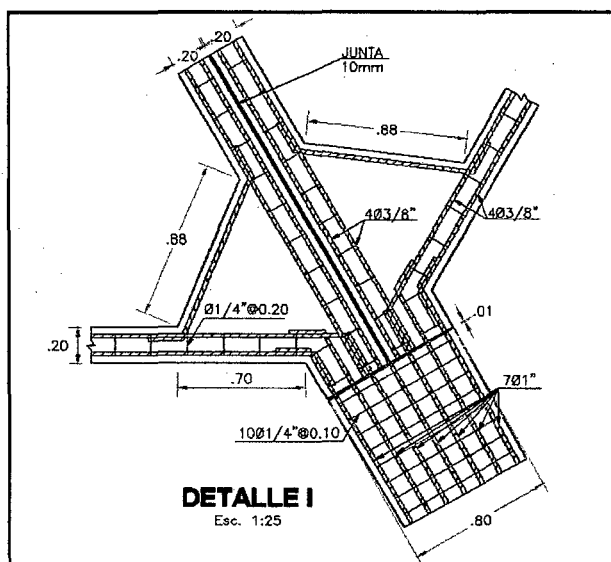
Vista en planta del detalle I de la Figura 6.36.
